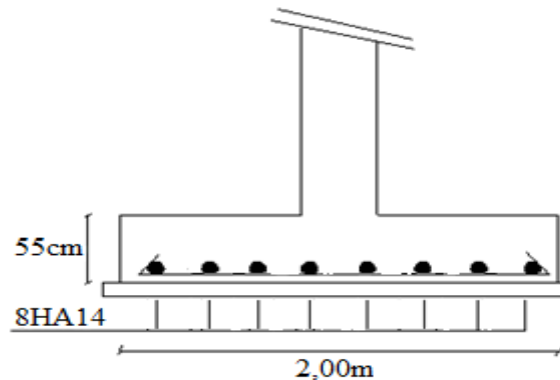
Ferrailage de la semelle intermédiaire dans le sens y-y.
